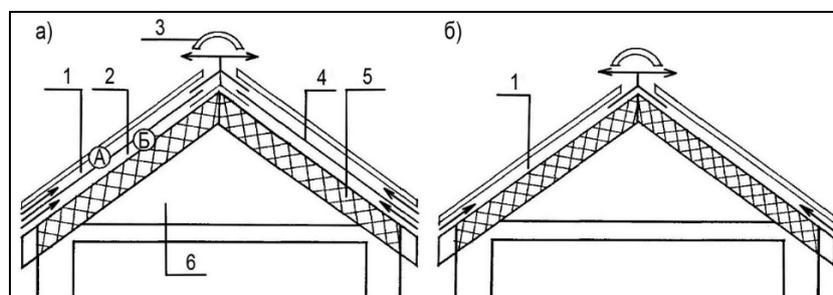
Кровля с двумя (рисунок 1.4.12, а) и одной (рисунок 1.4.12, б) вентиляруемыми воздушными прослойками; 1(А) и 2(Б) – соответственно верхняя и нижняя вентиляруемые воздушные прослойки, 1 – вентиляруемая воздушная прослойка, 3 – коньковый кровельный элемент, 4 – нижняя водоизоляция, 5 – утеплитель
